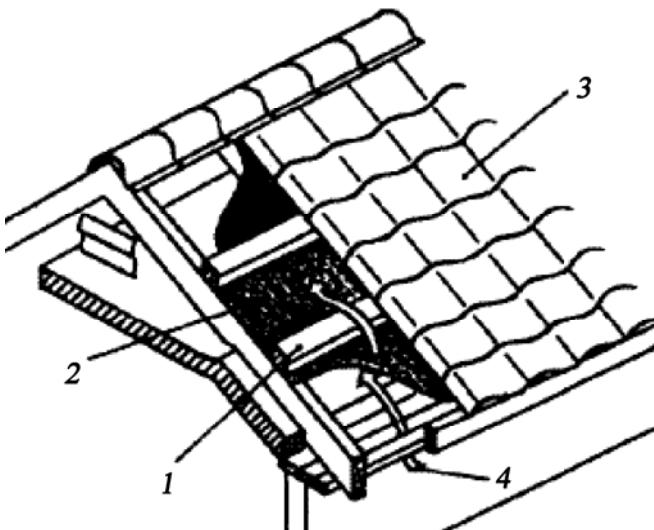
Конструкция крыши с кровлей из металличерепицы:
